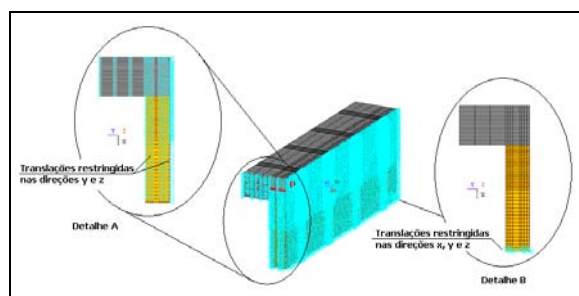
Condição de simetria e vinculação para o modelo de viga com conectores “verticais”.
